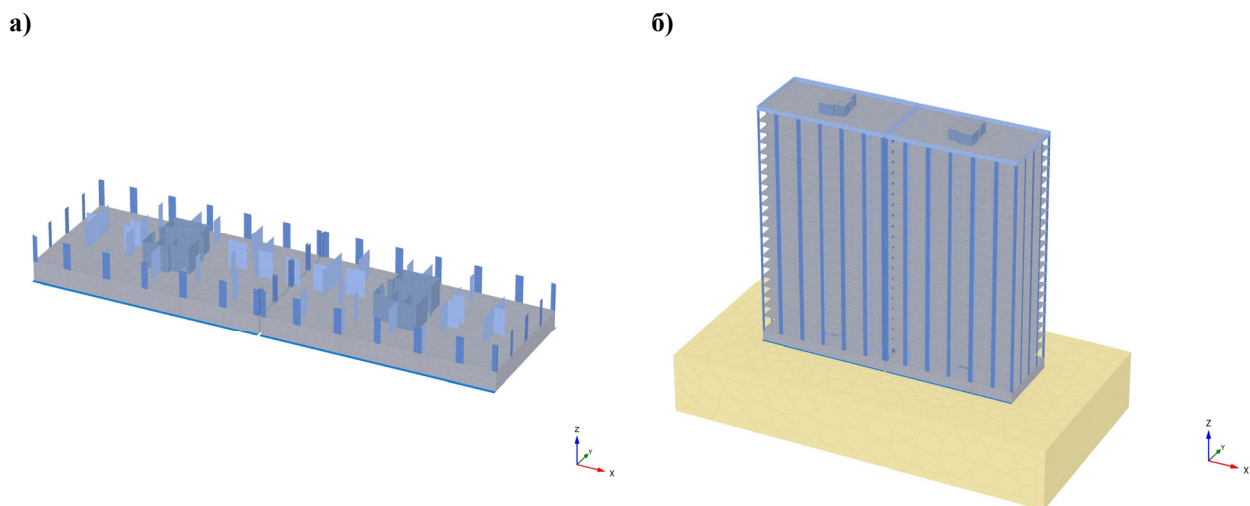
Загальні вигляди послідовного створення досліджуваної системи «основа – фундаменти – споруди»: а) схема з'єднання елементів каркасу з плитними фундаментами; б) система «основа – фундаменти – споруди»
